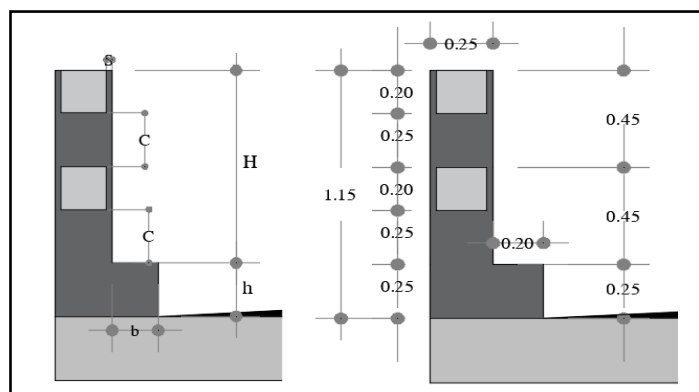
Dimensiones de la protección lateral poste – viga, corte transversal
